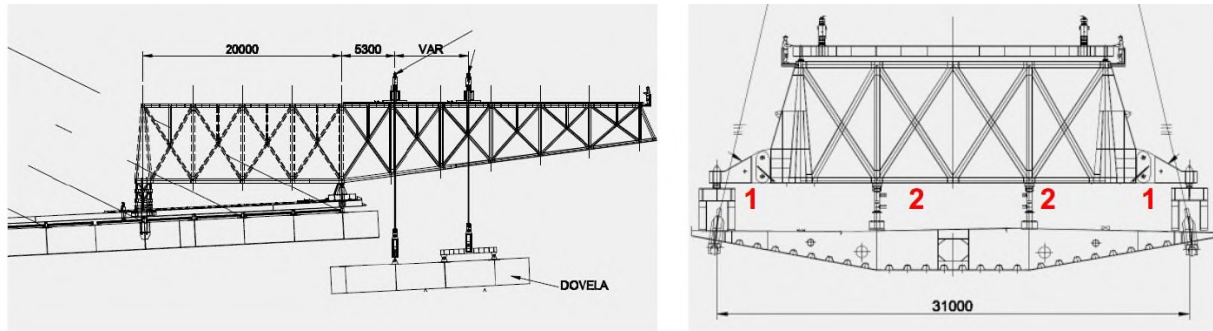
Sistema de apoyo del carro de izado. Puente de la Constitución de 1812.
